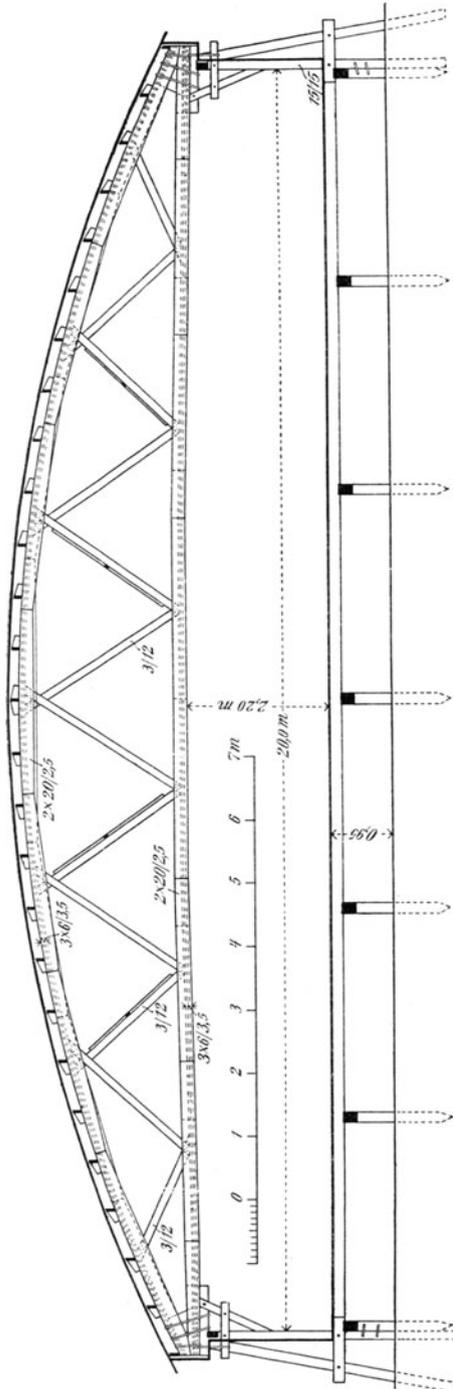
Arbeitshalle für den Bau der 5. Elbbrücke in Dresden.
